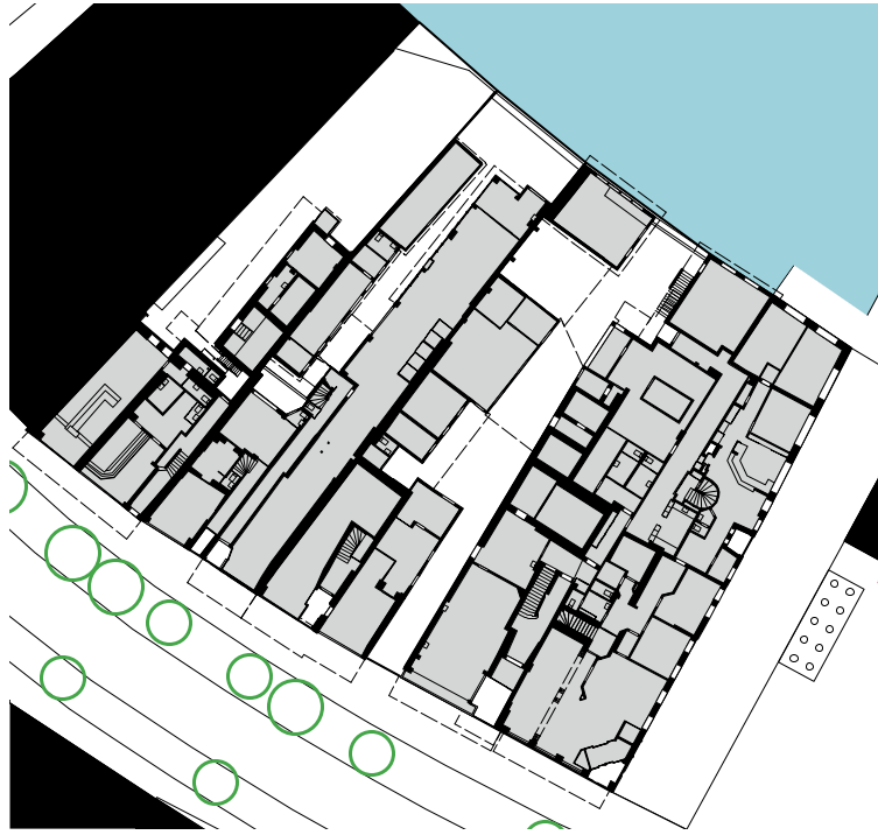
Aus dem 3D-Modell generierter Grundriss
